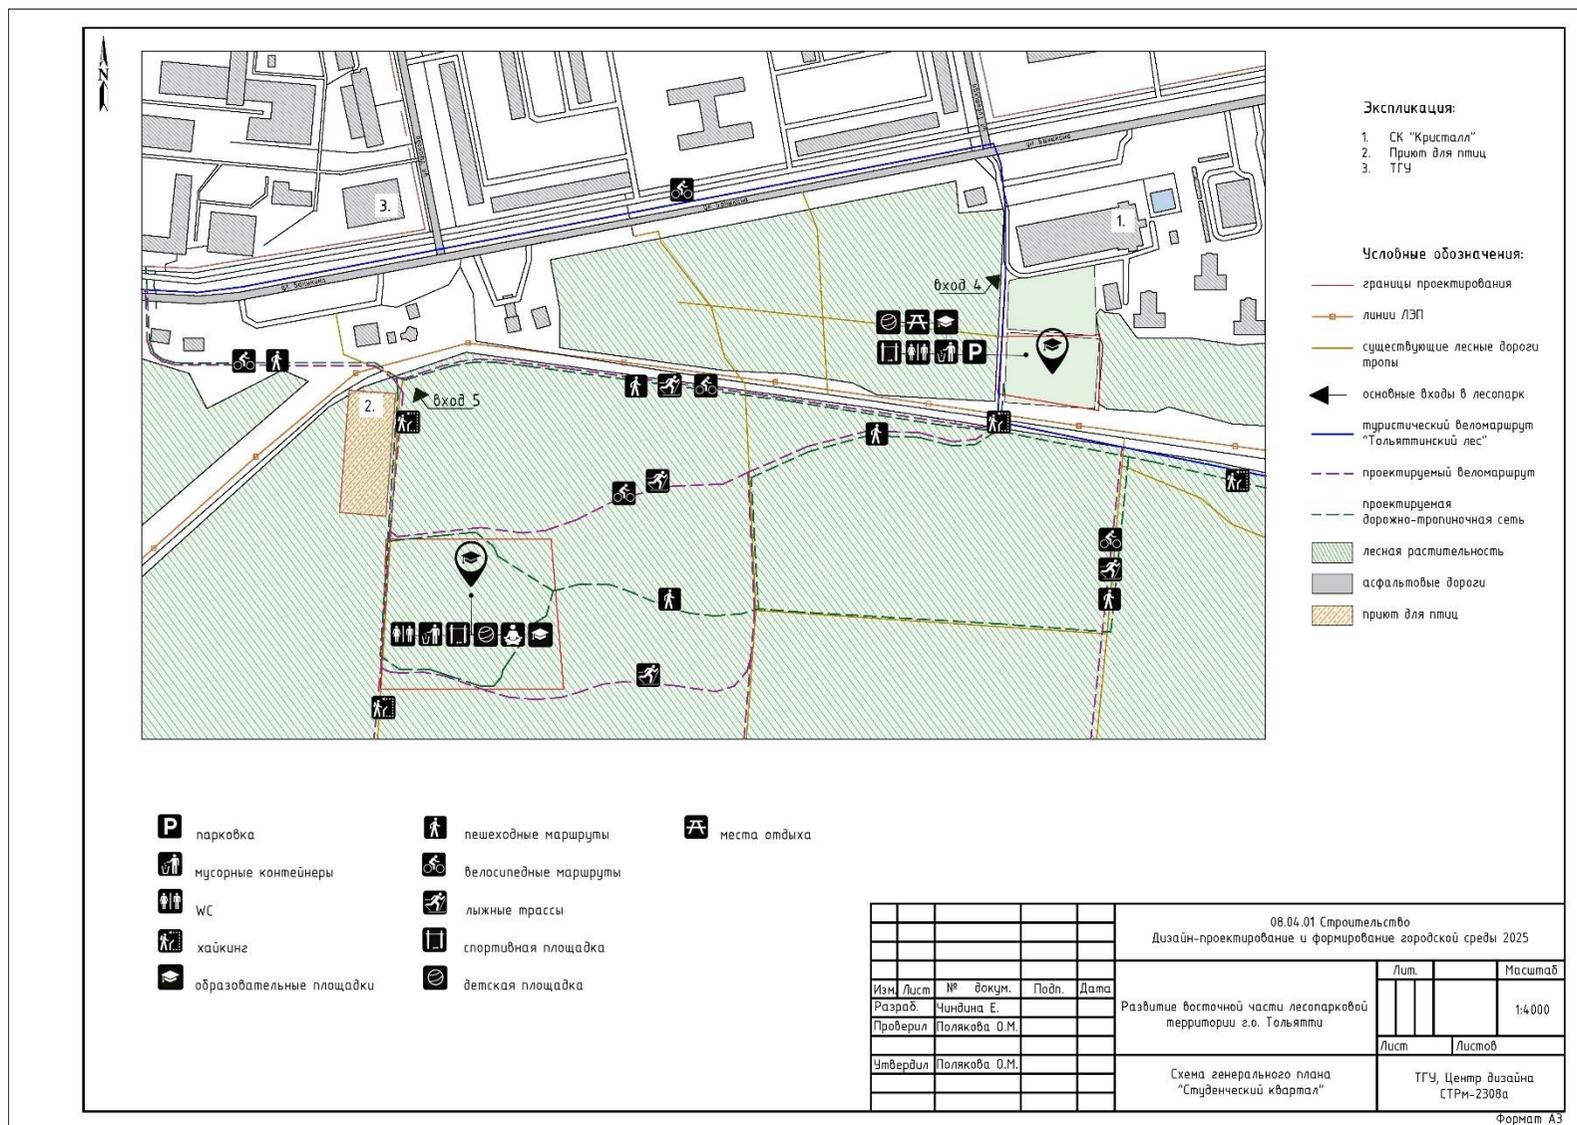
Фрагмент схемы генерального плана. Зона «Студенческий квартал»
